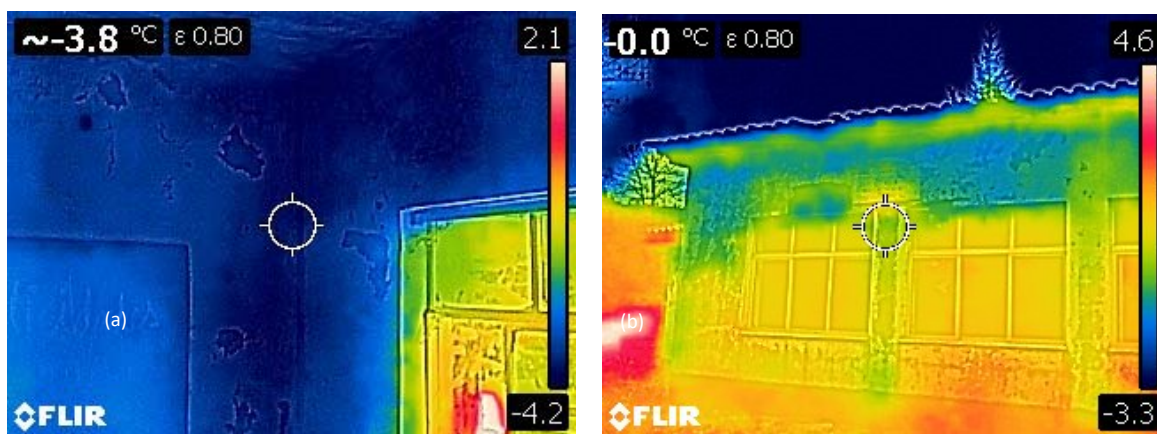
Imagens obtidas com câmara termográfica: (a) No interior em parede de fachada junto ao pilar P4, e (b) No exterior em parede de fachada.
